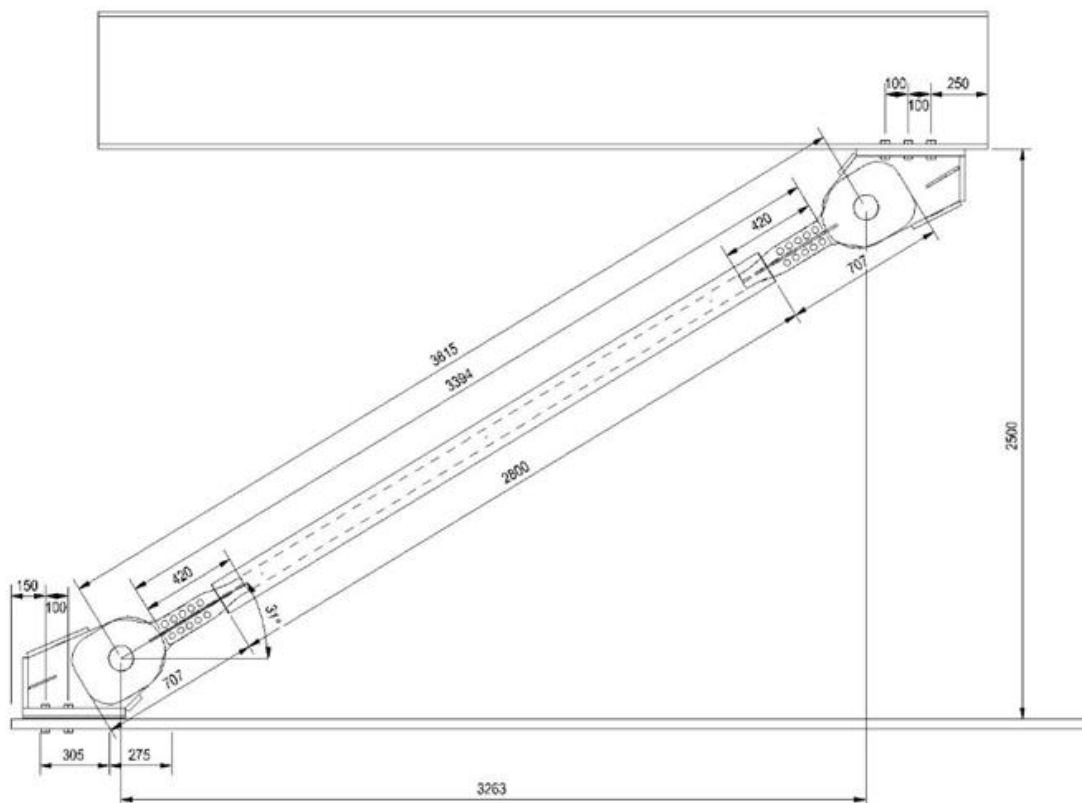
Dimensiuni cadru testare prototipuri BRB
